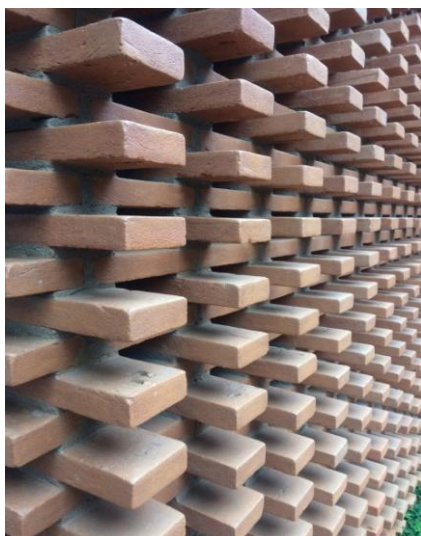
Parede de tijolos aparentes aplicados em construção recente, de 2016, em São Paulo, SP
